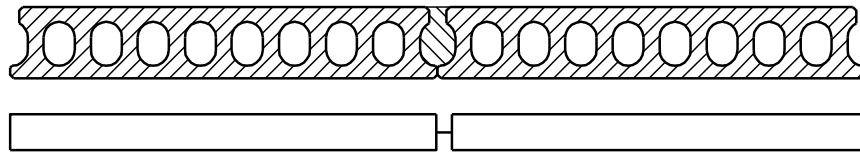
Esquema de junta não fendilhada entre painéis.
